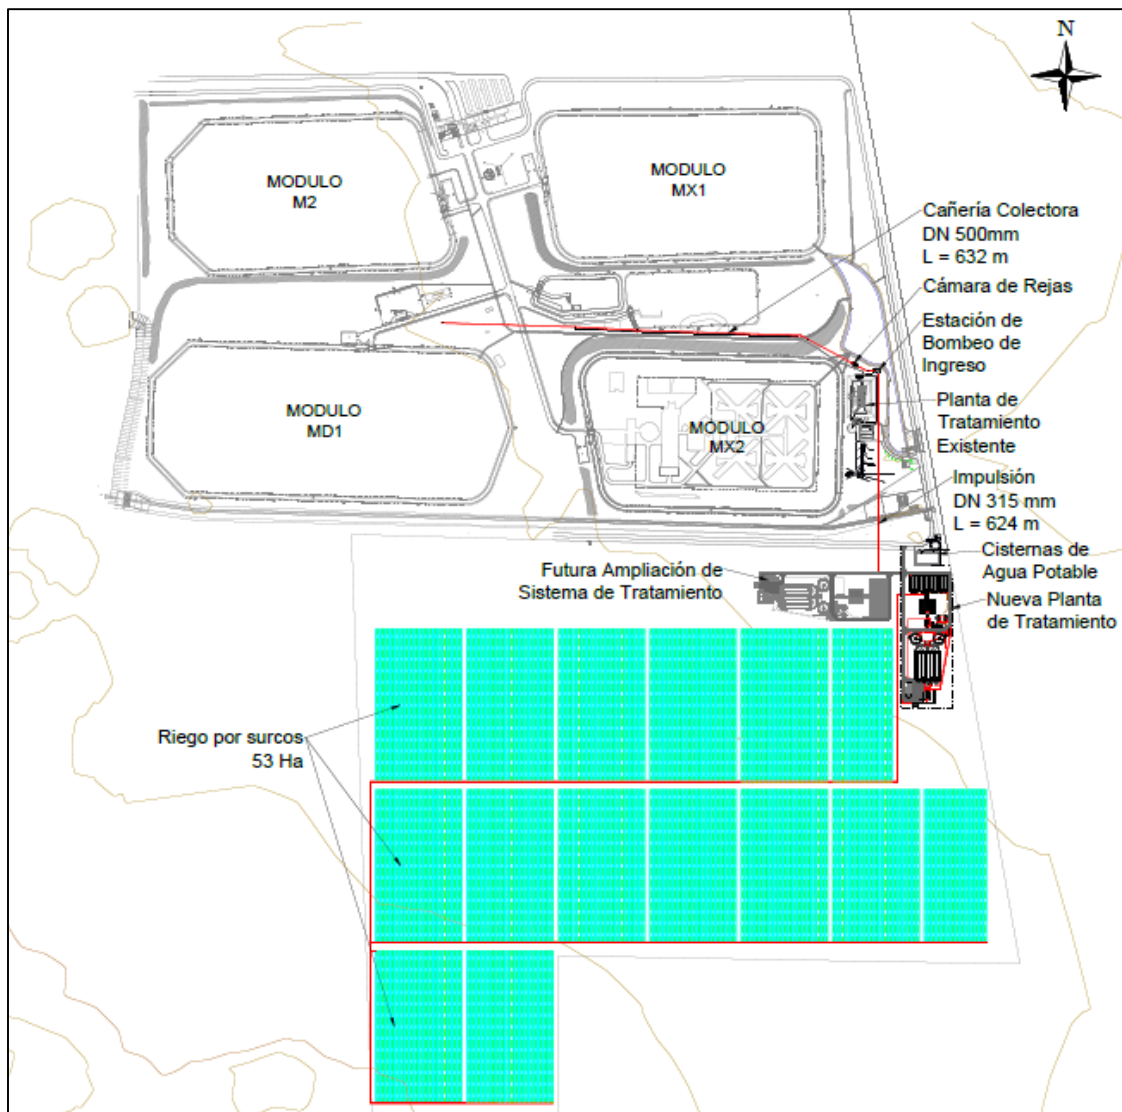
Planimetría general del establecimiento penitenciario de Bouwer y el sector en el que se emplazará la planta de tratamiento.
